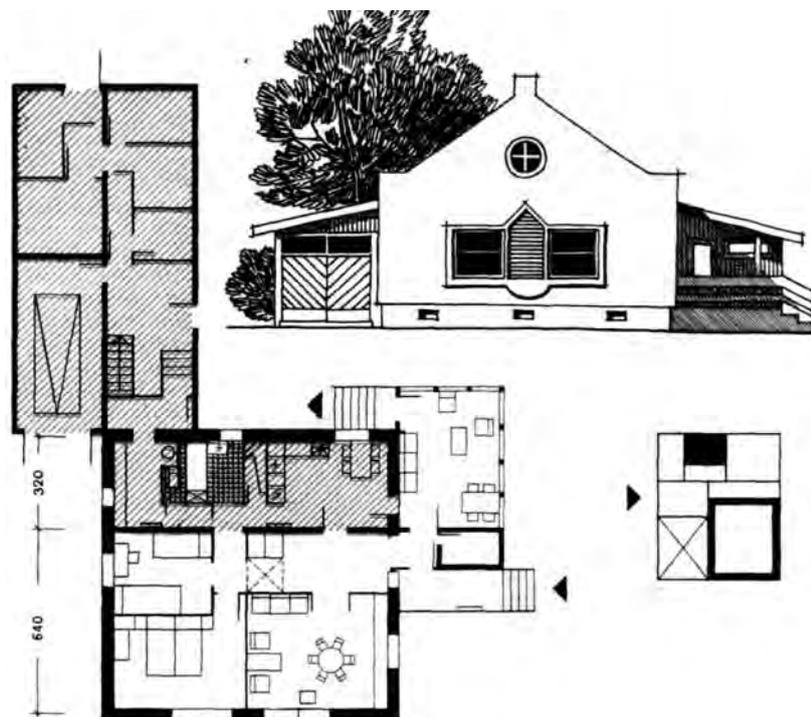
Трехкомнатный жилой дом с входом с боковой стороны, хозяйственная зона с задней стороны дома. План этажа, схема двухэтажного дома, фасад
